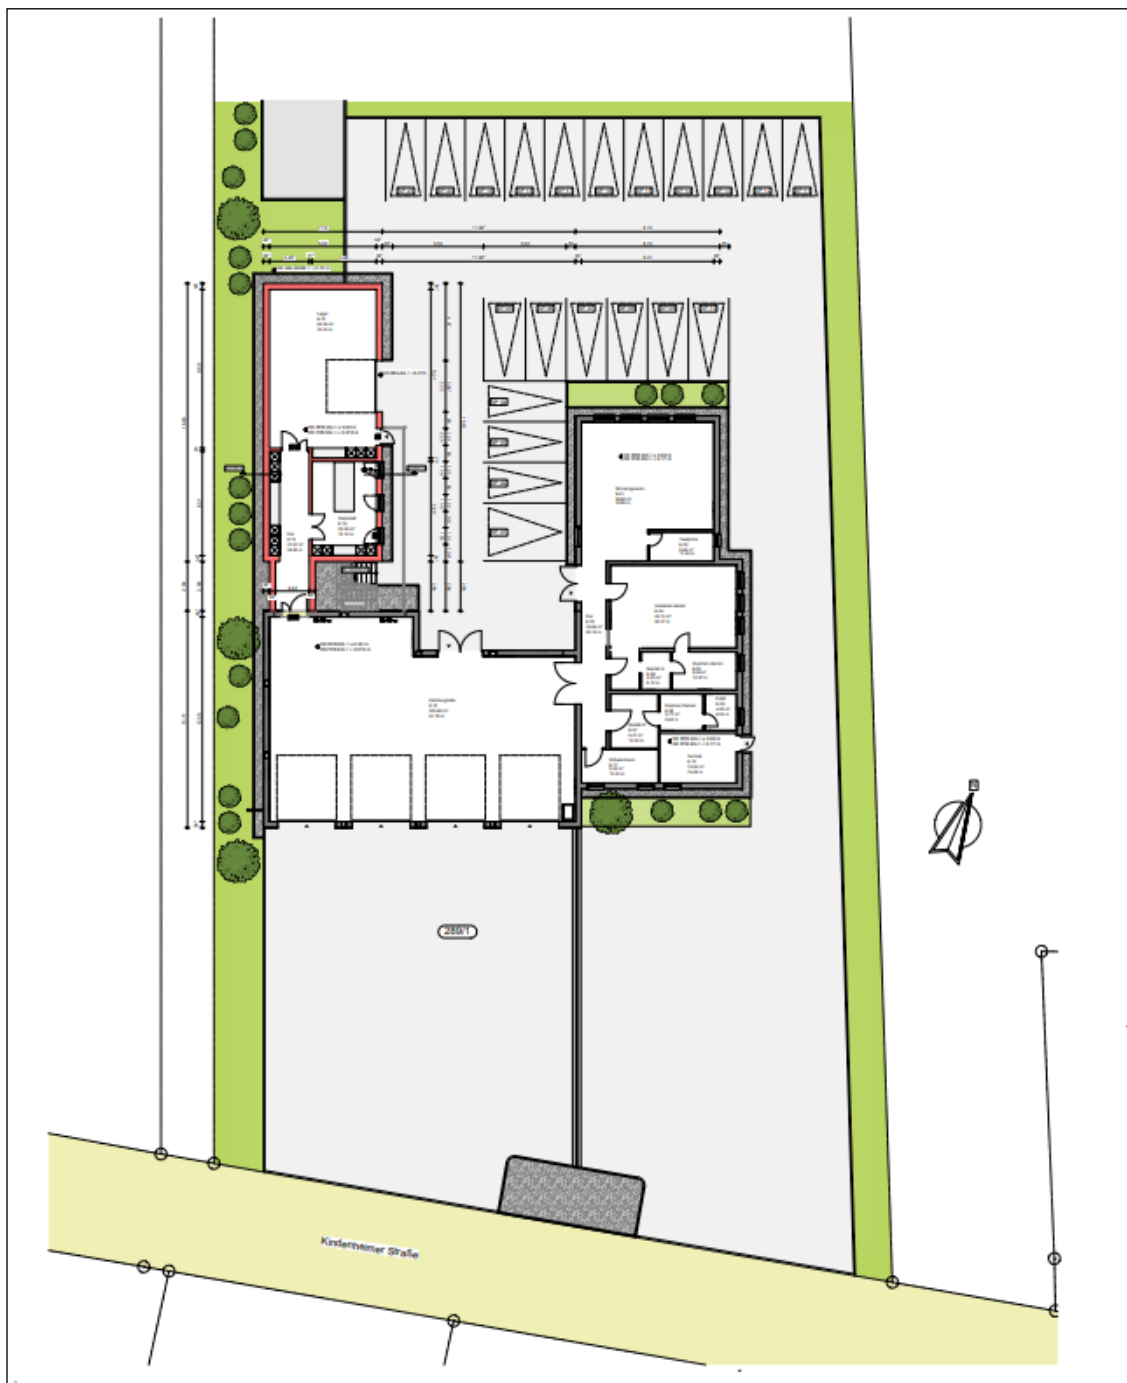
Lageplan des Gesamtvorhabens. David Kölsch, freier Architekt, 04.03.2023
